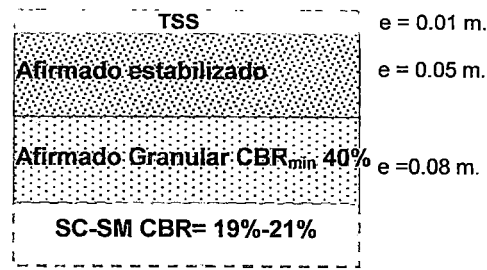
Estructura del pavimento con tratamiento superficial simple⁴⁷.
